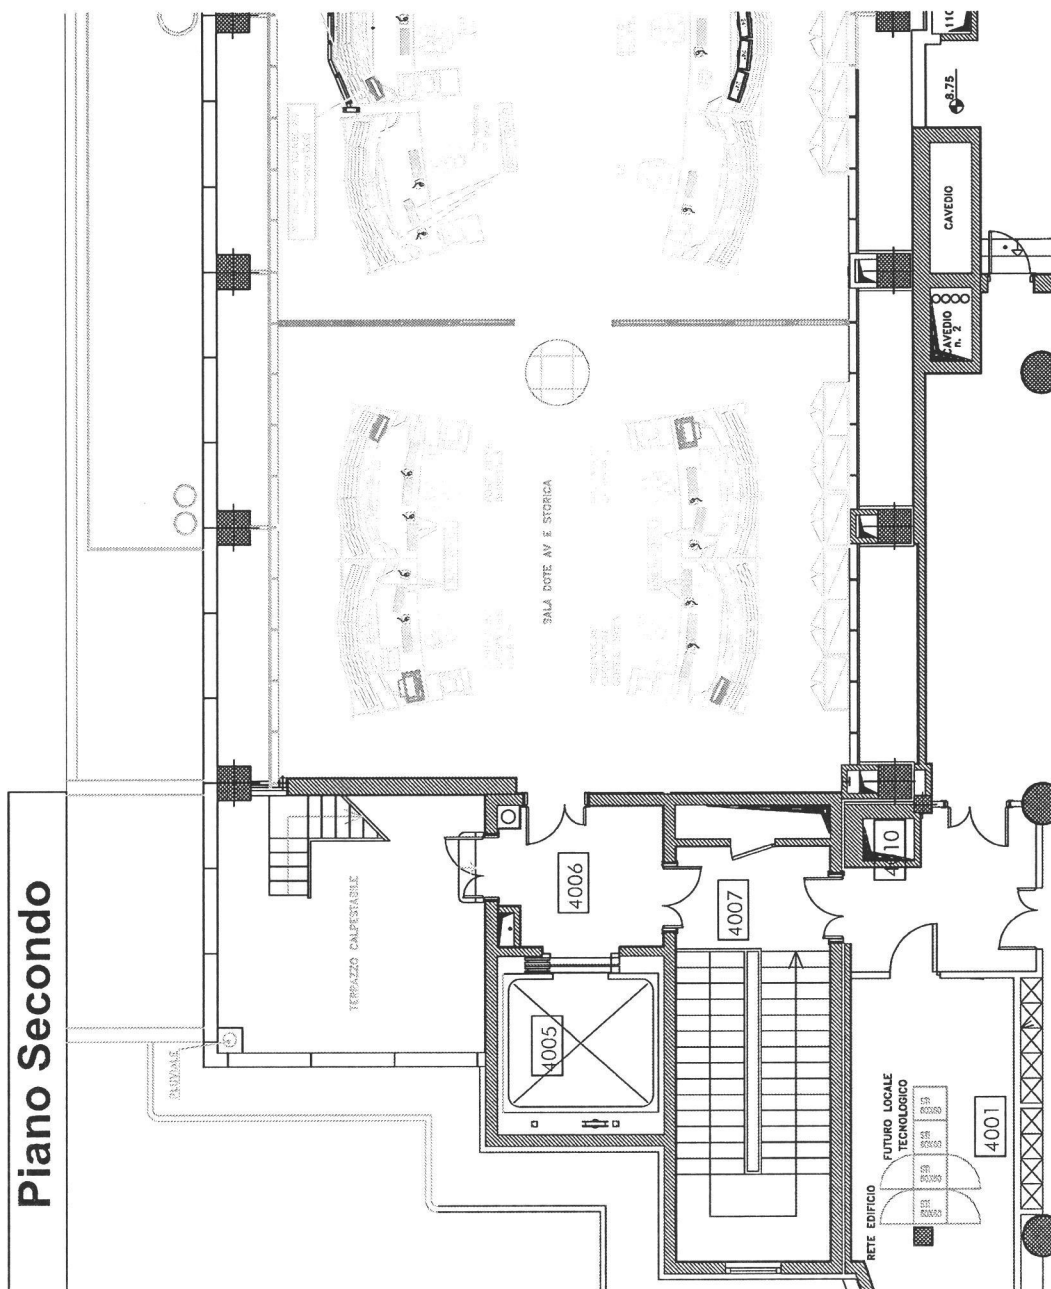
“ Layout edificio DOTE – Primo Secondo ”
